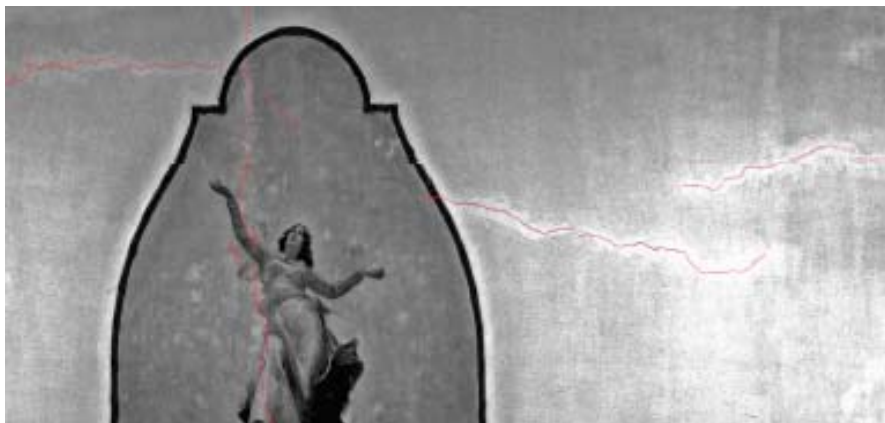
Fissuras vetorizadas (em vermelho) no teto da Igreja Paroquial de Cascais
